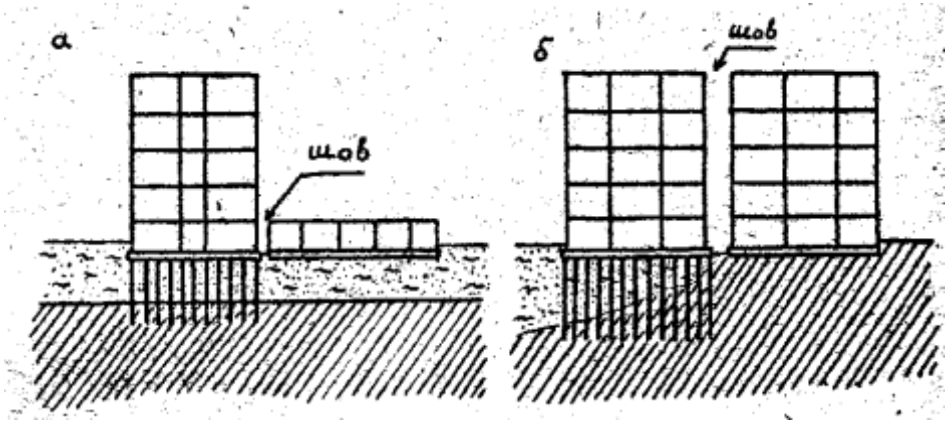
Типы оснований и фундаментов: а – разные по нагрузкам фундаменты при одинаковом грунтовом основании; б – одинаковые по нагрузкам фундаменты при разных грунтовых основаниях
